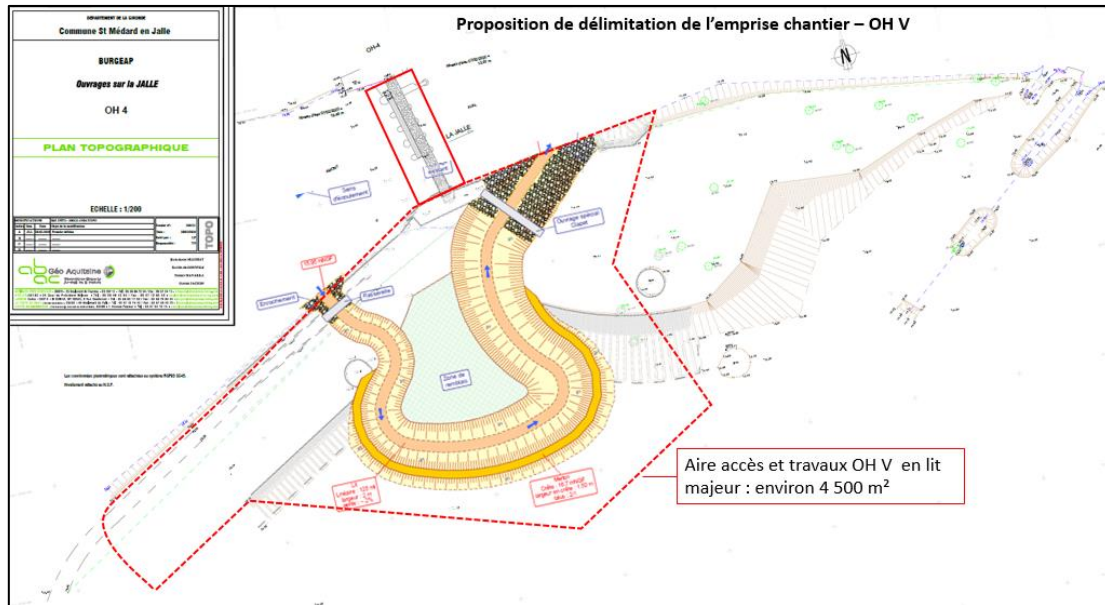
Localisation de la zone travaux au droit de l'OH V (source : Plan topographique avec annotations BURGEAP)
